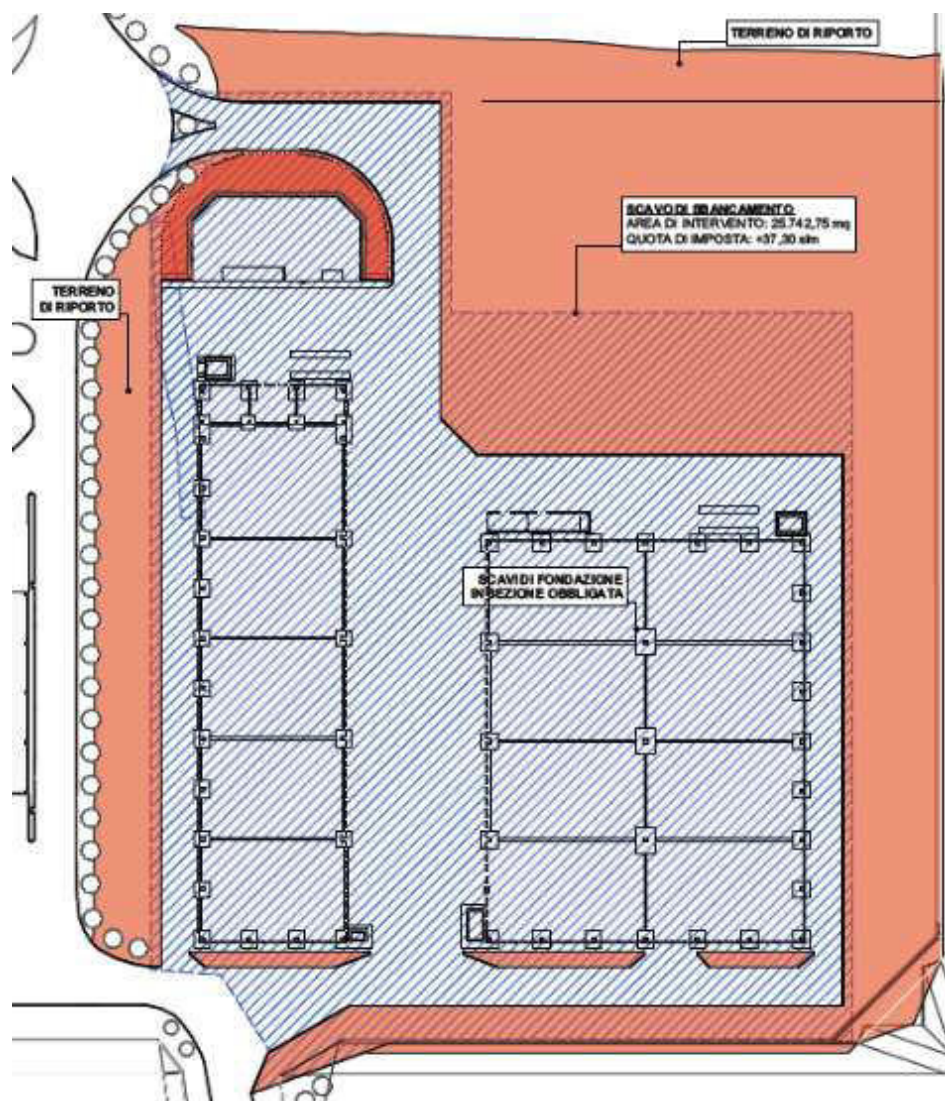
Planimetria Scavi e riporti di terreno. Retino azzurro: sbancamento fino a 1,10 m da p.c.; in arancio: riporti di terreno; elementi in nero entro area di sbancamento: scavi di fondazione fino a 1,50 m da p.c.
